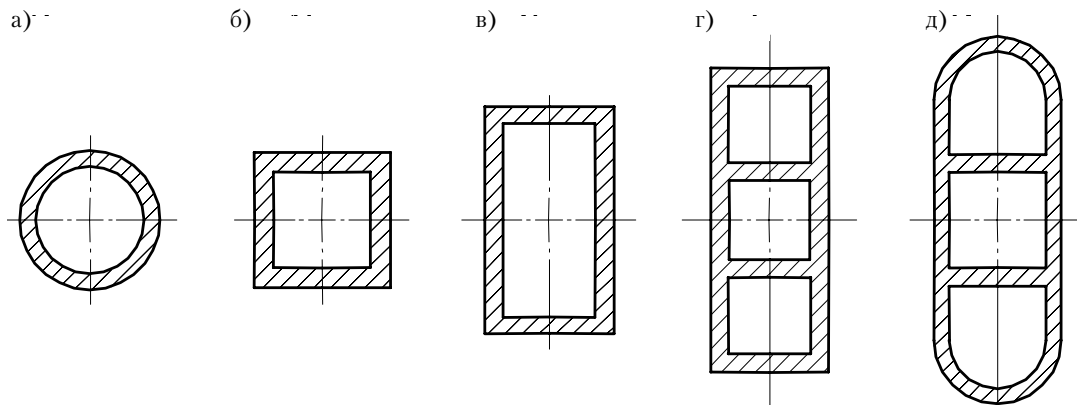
Формы поперечного сечения опускных колодцев: а) круглая; б) квадратная; в) прямоугольная; г) прямоугольная с поперечными перегородками; д) с закругленными торцевыми стенками.
